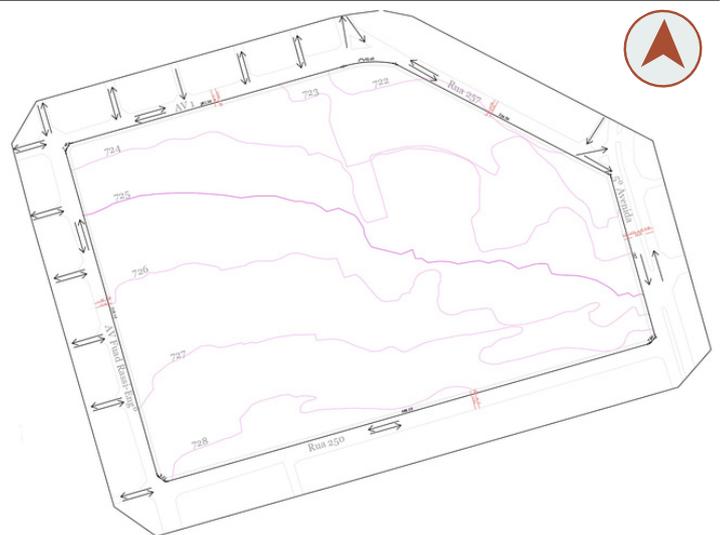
Planta de circulação do entorno. Fonte: Acervo Pessoal.
